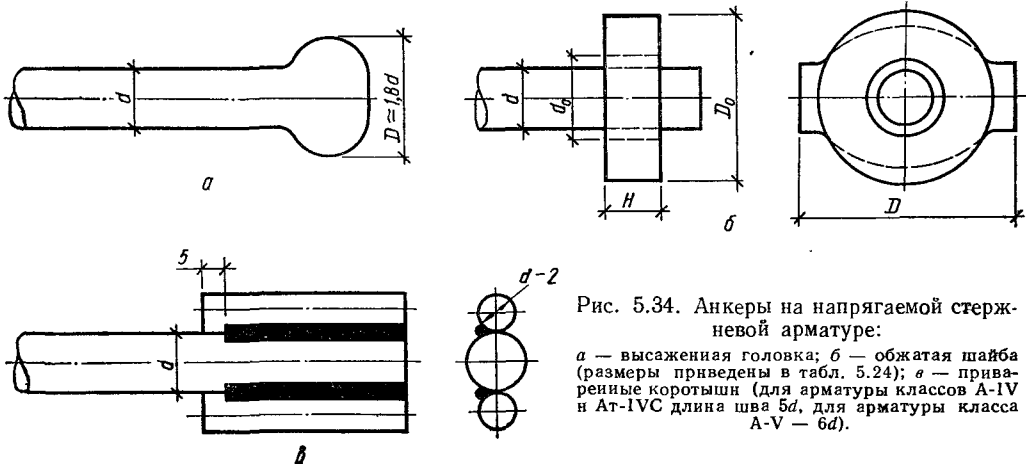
Анкеры на напрягаемой стержневой арматуре:
